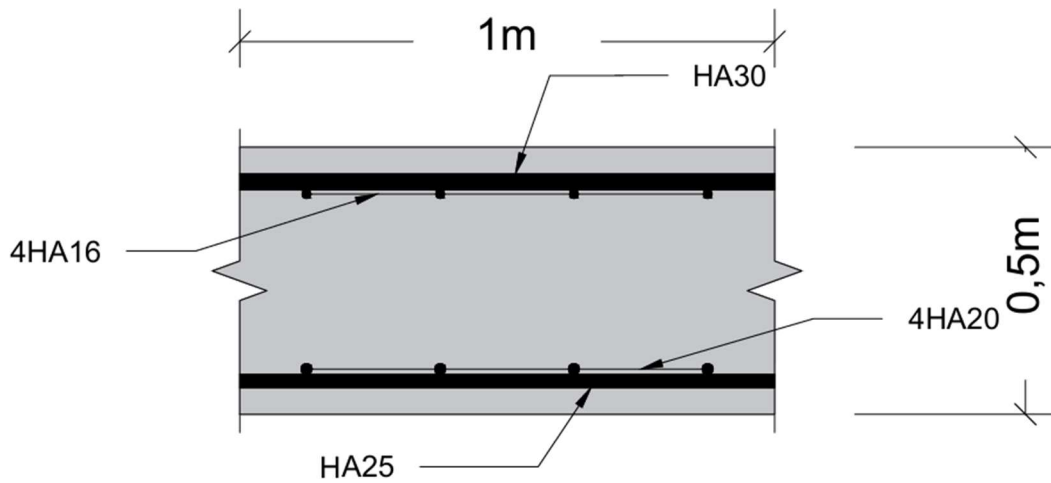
Ferrailage de la dalle du terre-plein coupe B-B.
